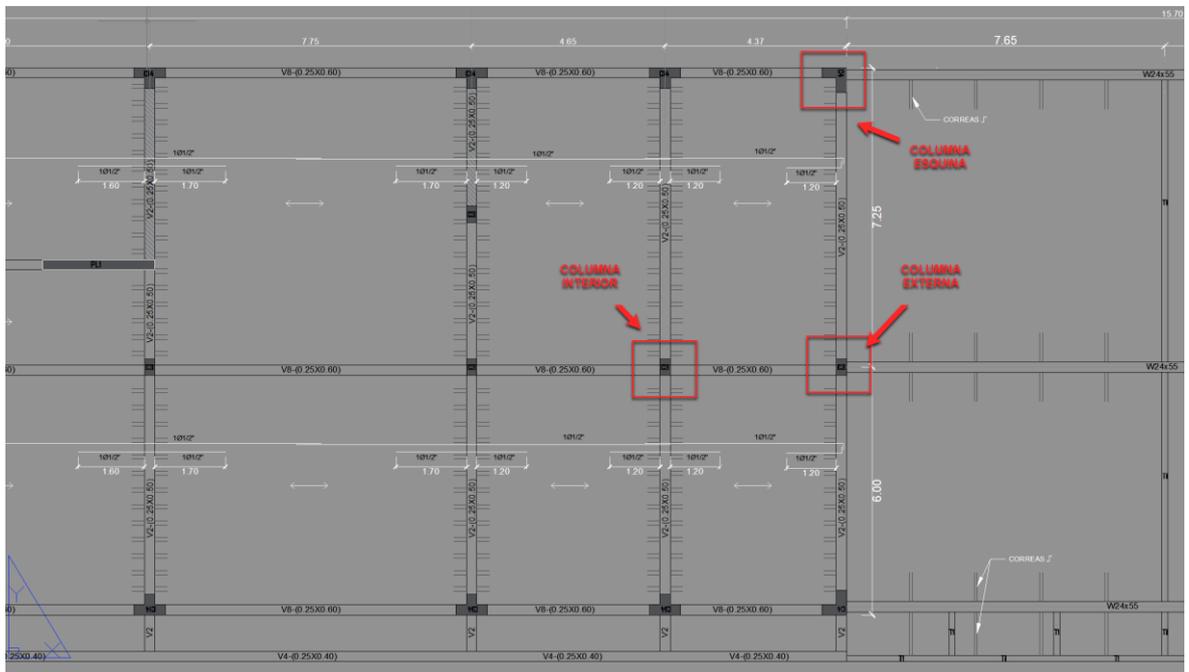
PREDIMENSIONAMIENTO DE COLUMNAS
